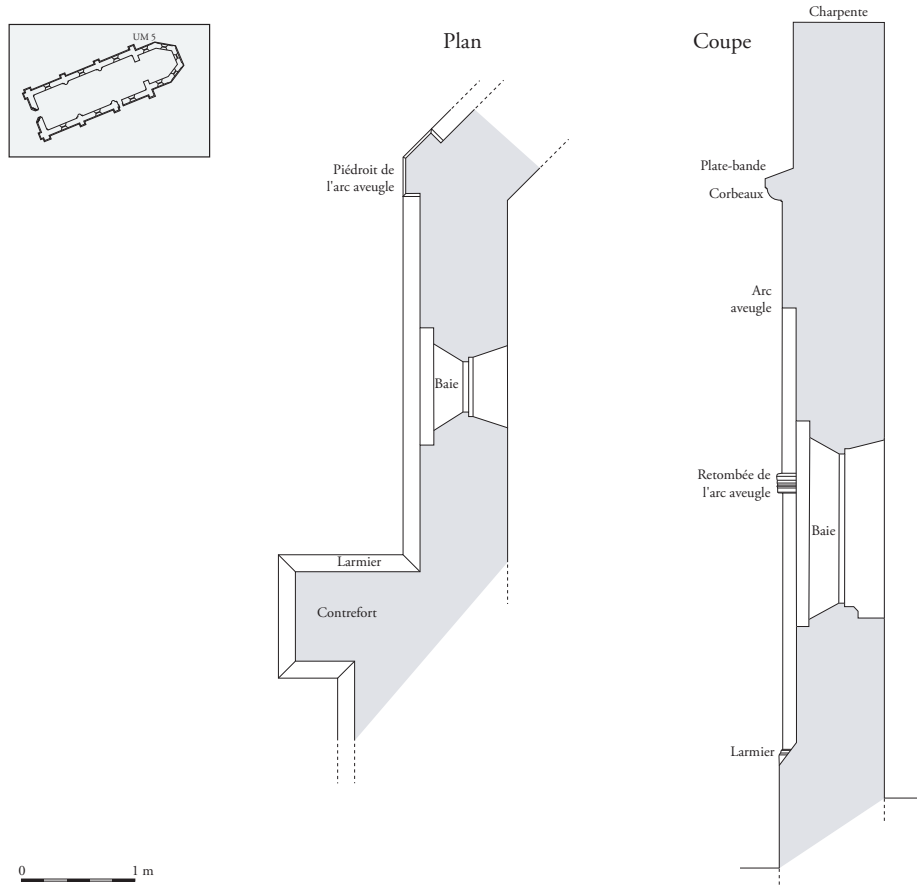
Plan et coupe d'un pan du chevet (DAO Cédric Moulis).
